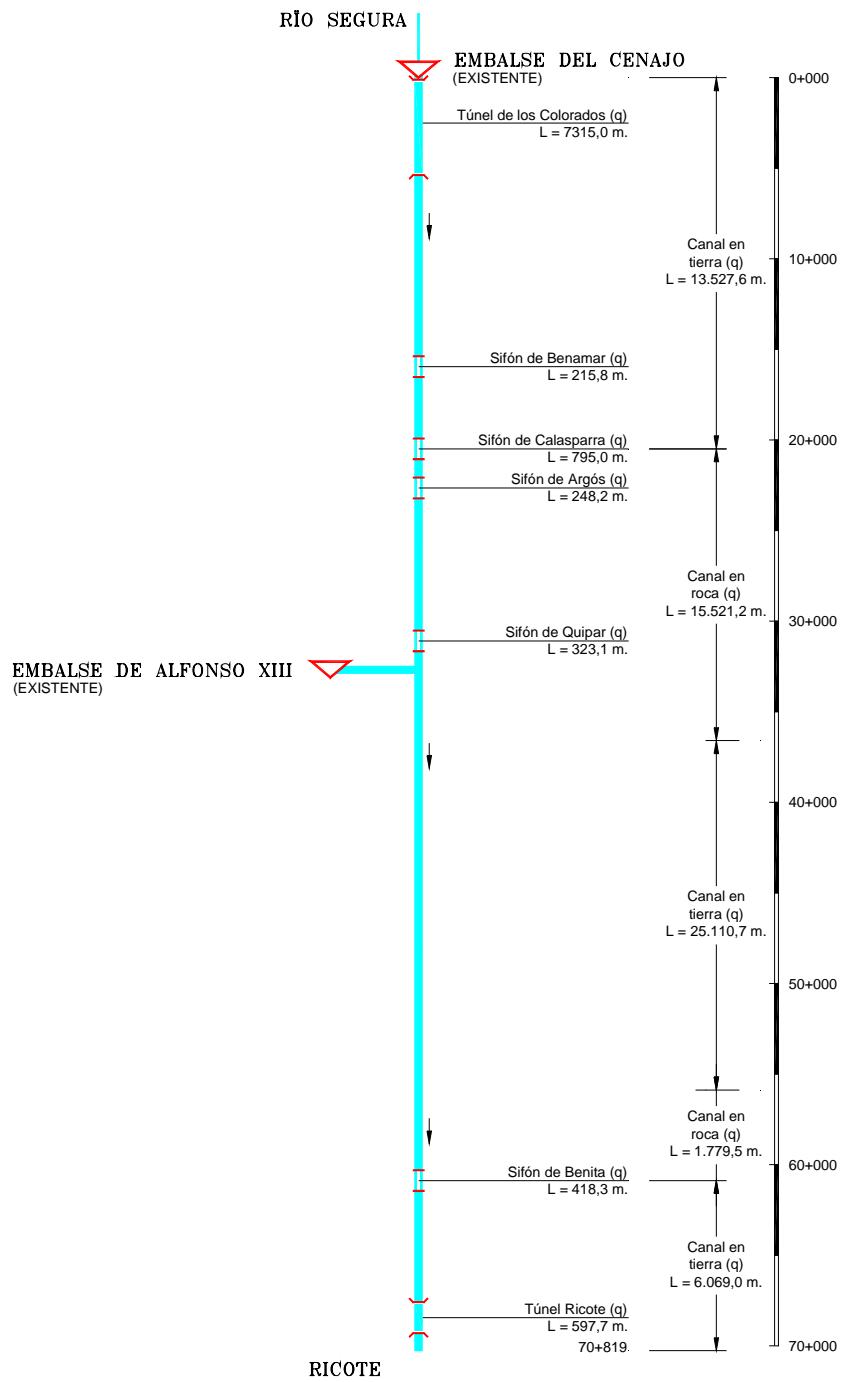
Conducción Cenajo-Ricote. Esquema en planta
